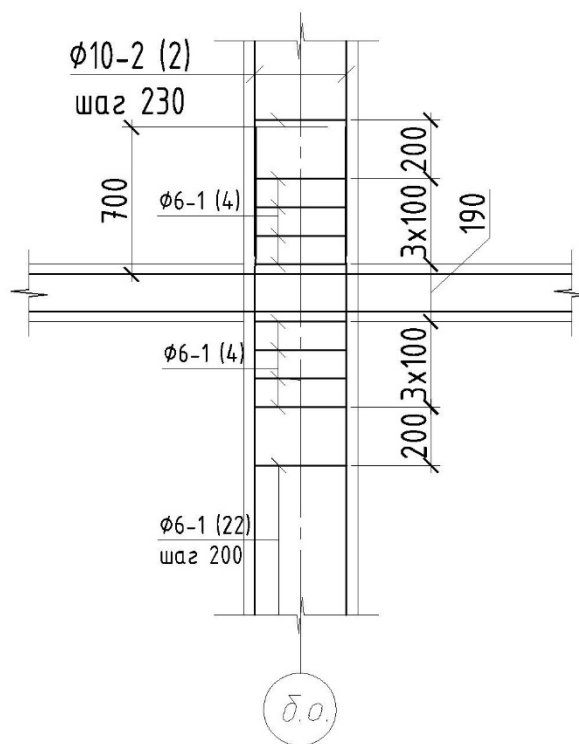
Типовой узел сопряжения колонны и перекрытия в монолитном железобетонном каркасе каркаса
